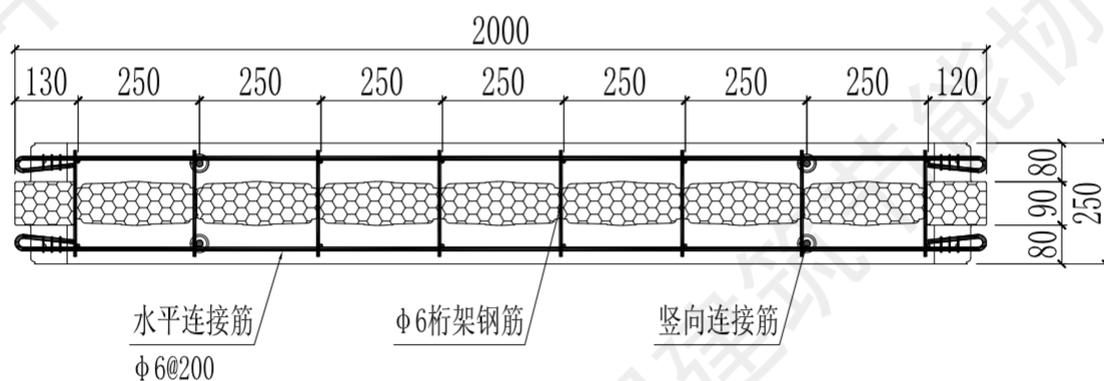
(a) 无肋自保温结构墙体横截面二维平面图
